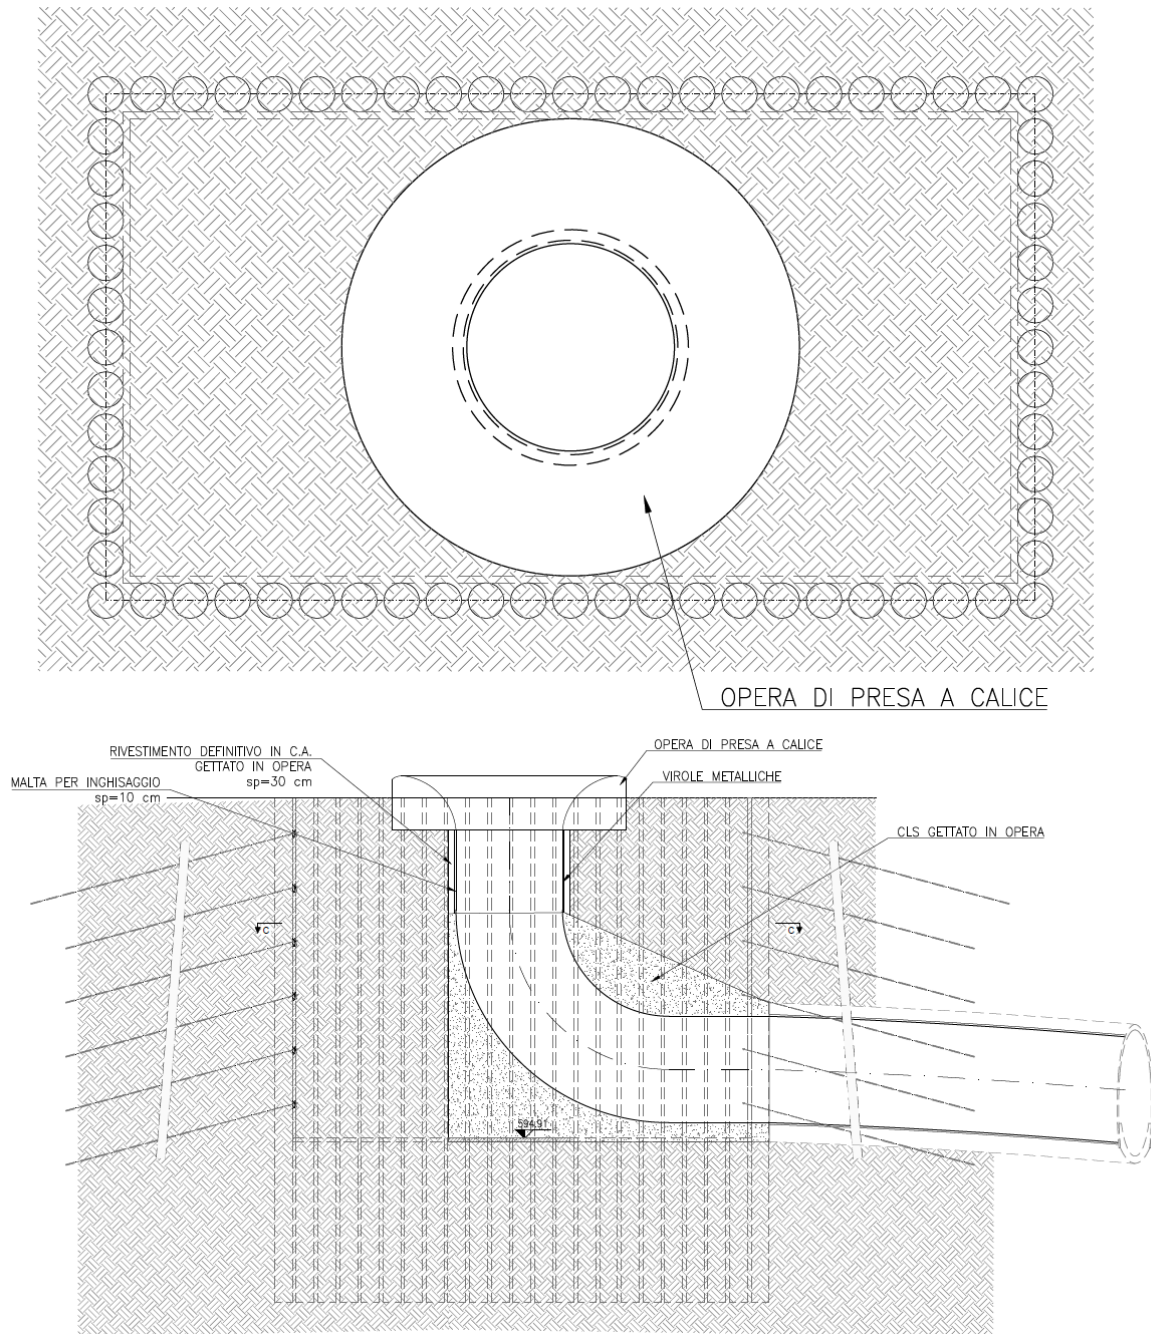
Pozzo forzato: planimetria e sezione trasversale della configurazione finale
